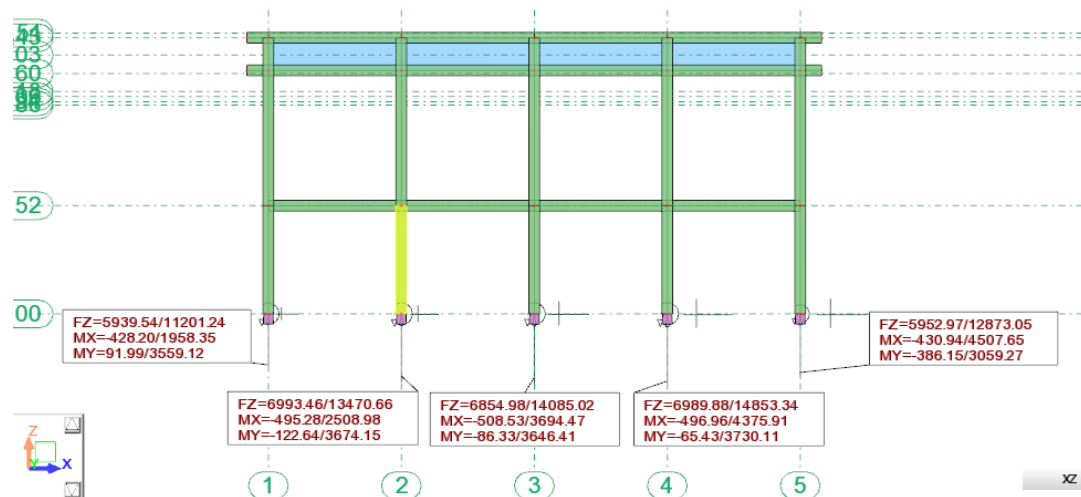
Fuerzas y momentos actuantes en columnas. Vista frontal, eje C (plano xz).
